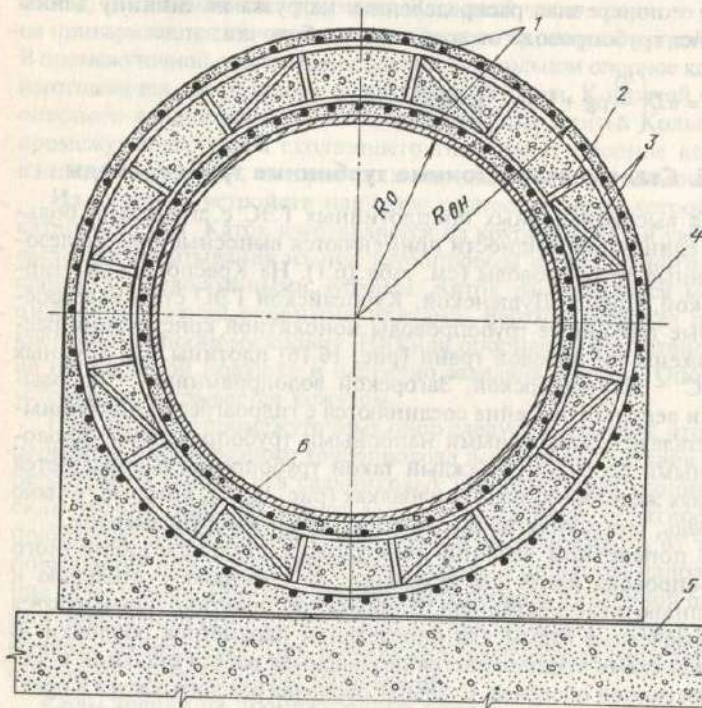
Сталежелезобетонный выносной трубопровод приплотинной ГЭС:
